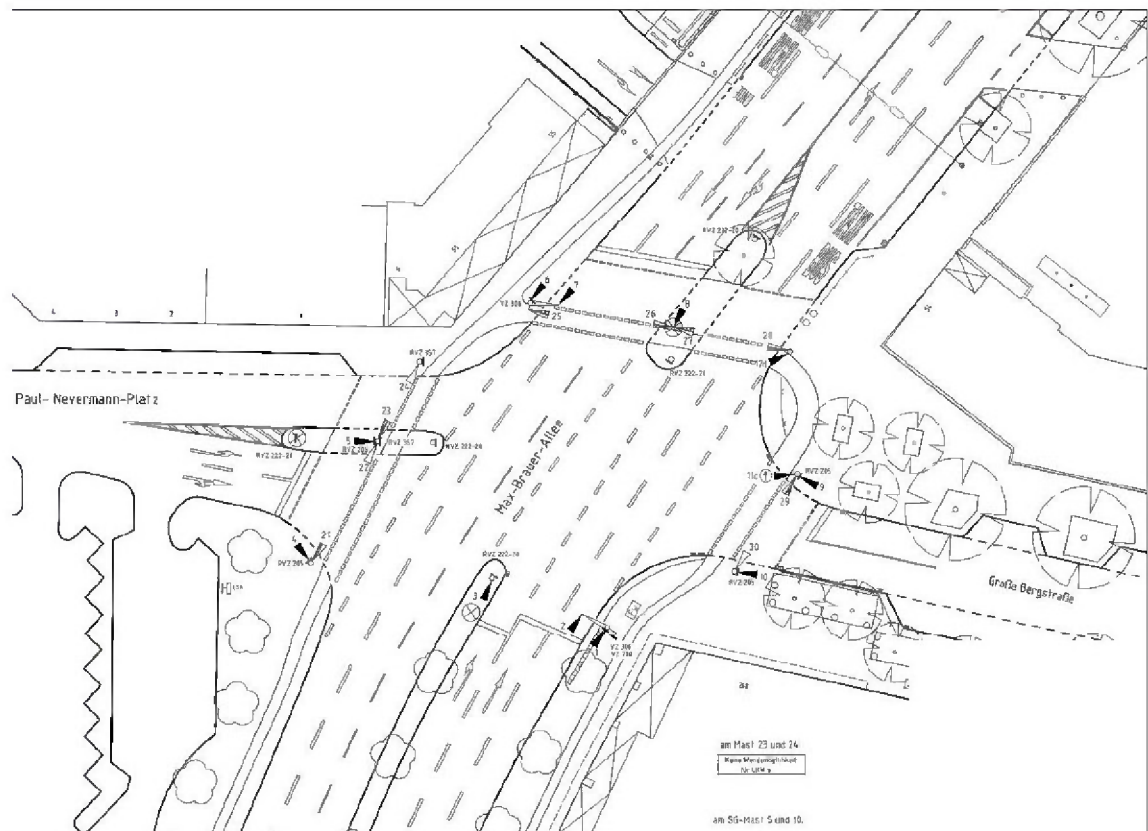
Signallageplan Max-Brauer-Allee/Große Bergstraße – Bestand (01/321-04-05/05)
